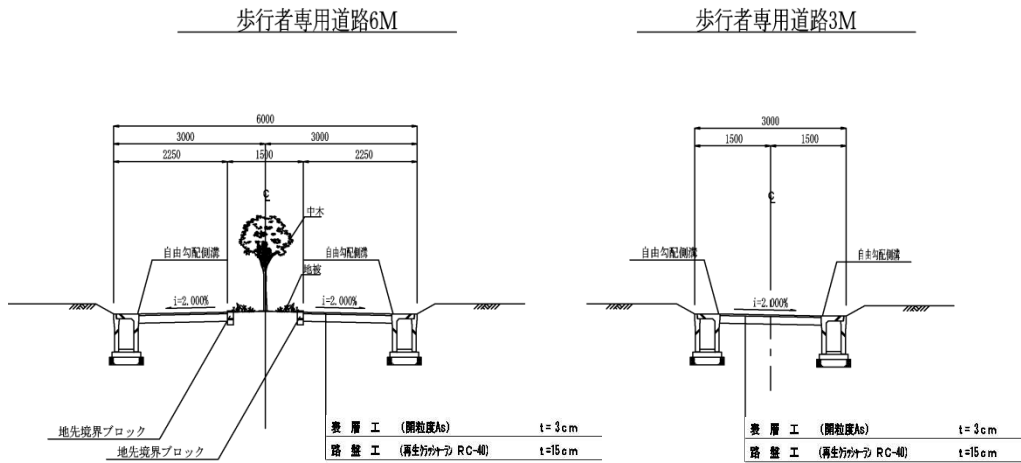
(6) 道路断面図(区画道路:6m 標準断面)
